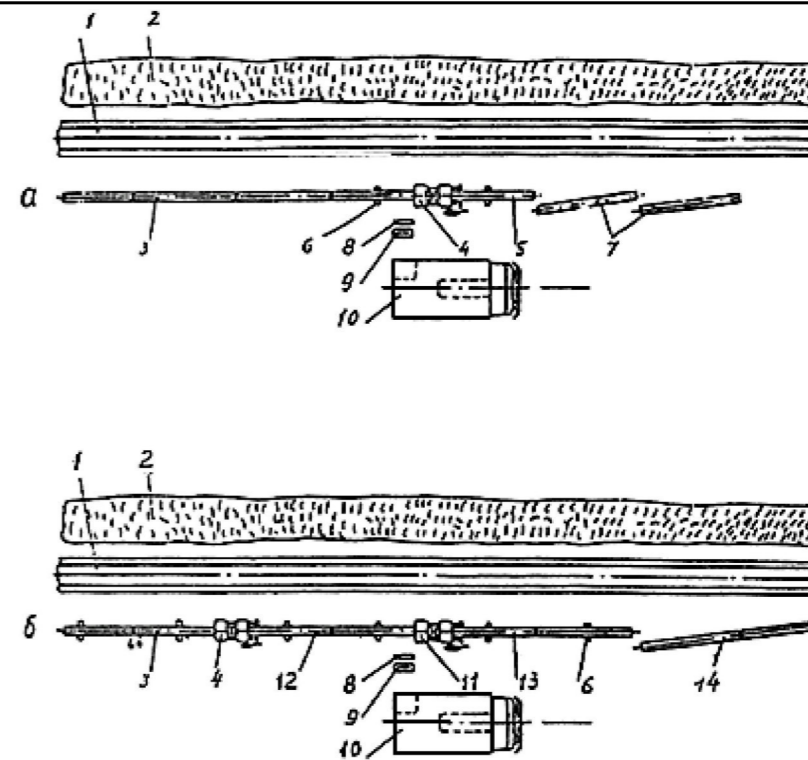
Схемы сварки трубопровода в нитку: а) из одиночных труб с использованием одного центризатора (сварочной установки); б) из двухтрубных секций с использованием двух центризаторов; 1 – траншея; 2 – отвал грунта; 3 – свариваемый трубопровод; 4 – центризатор (сварочная установка); 5 – привариваемая труба; 6 – лежки или инвентарные опоры; 7 – трубы; 8 – устройство для механической обработки торцов труб; 9 – нагревательный инструмент; 10 – передвижная электростанция на базе автомобиля; 11 – дополнительный центризатор; 12 – приваренная к трубопроводу секция; 13 – привариваемая секция; 14 – двухтрубная секция
